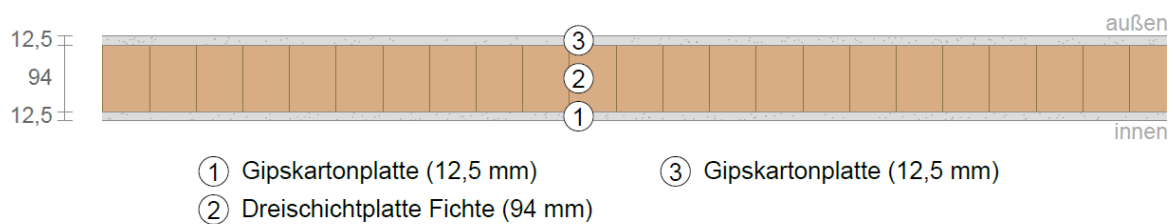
Aufbau KLH Innenwand, tragend. Erstellt mit U-Wert.net
